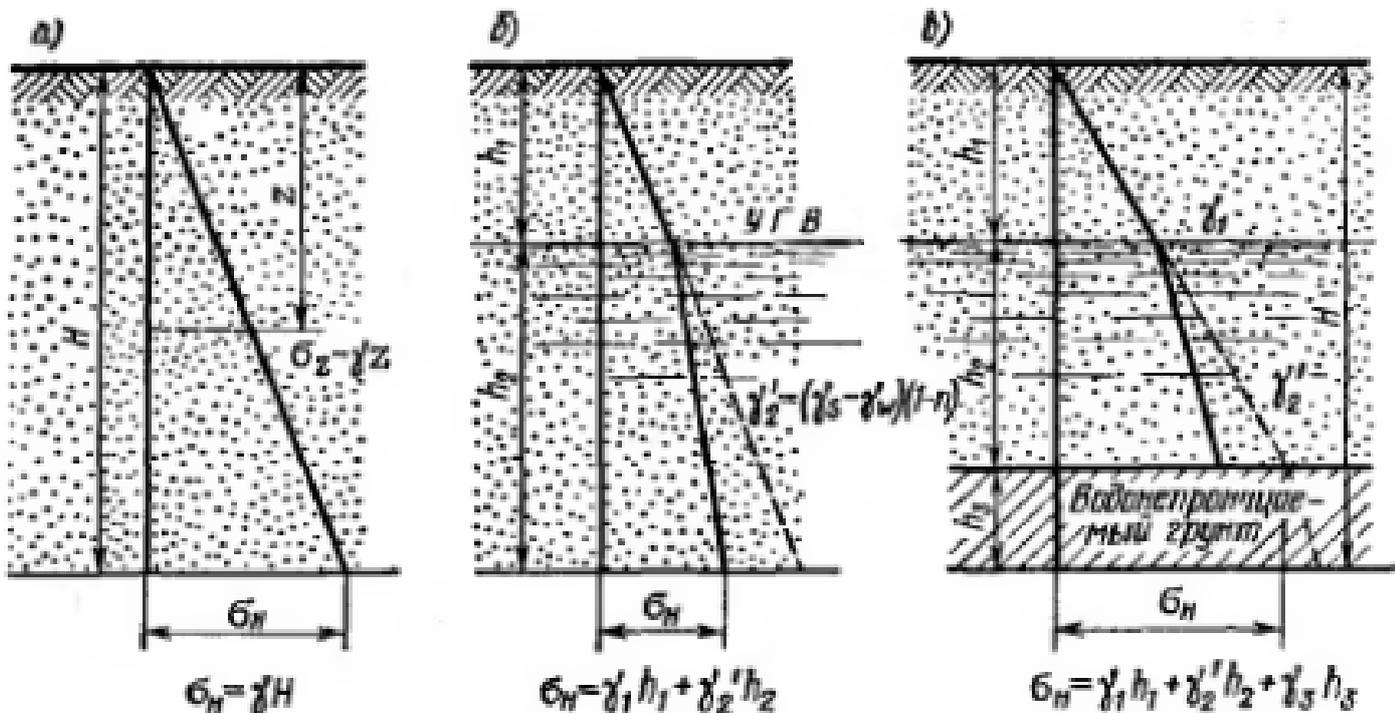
Распределение давлений от собственного веса грунта: а — в однородном грунте; б — при наличии (на глубине h_1 ,) уровня грунтовых вод; при наличии под грунтовыми водами (на глубине $h_1 + h_2$) водонепроницаемой породы
